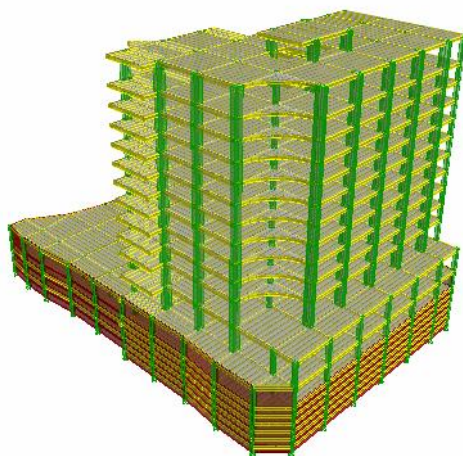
Modelo estructural edificio Campestre Towers en 3D
